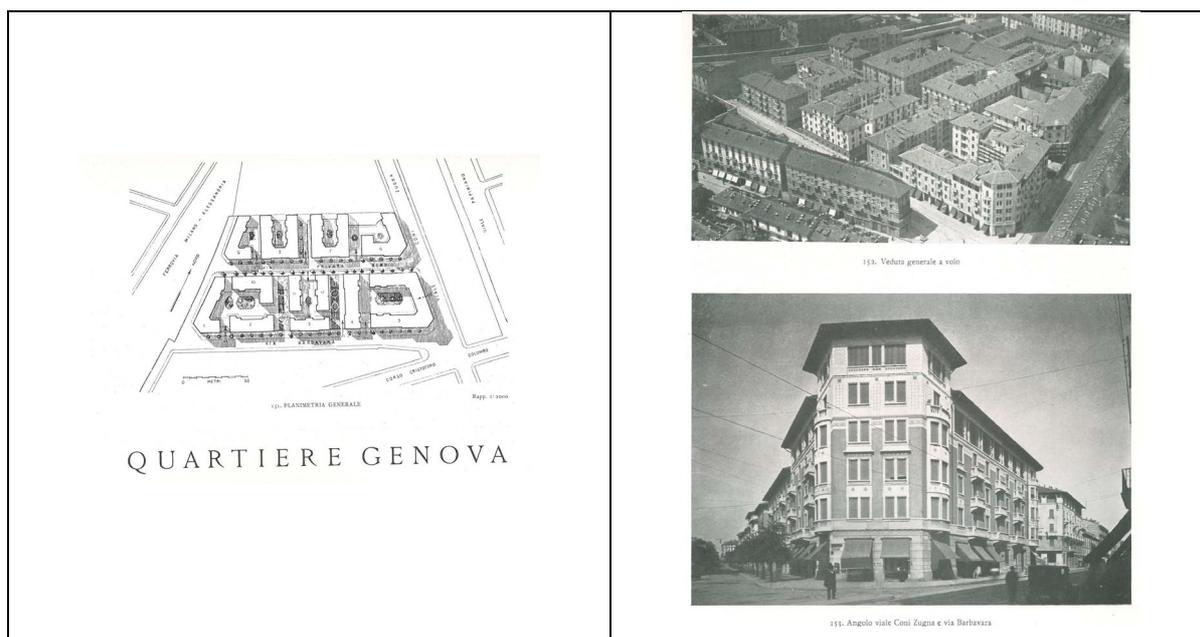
Quartiere Genova. Planimetria. Pianta generale e foto d'epoca
